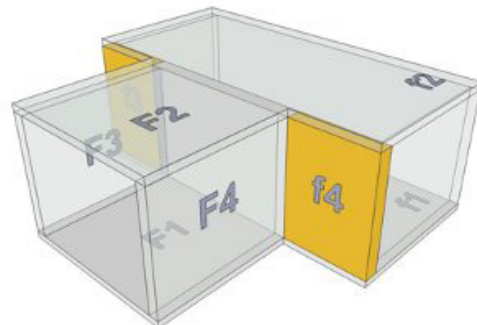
71 Pareja de recintos: Caso planta baja: comedor- caja de escaleras
